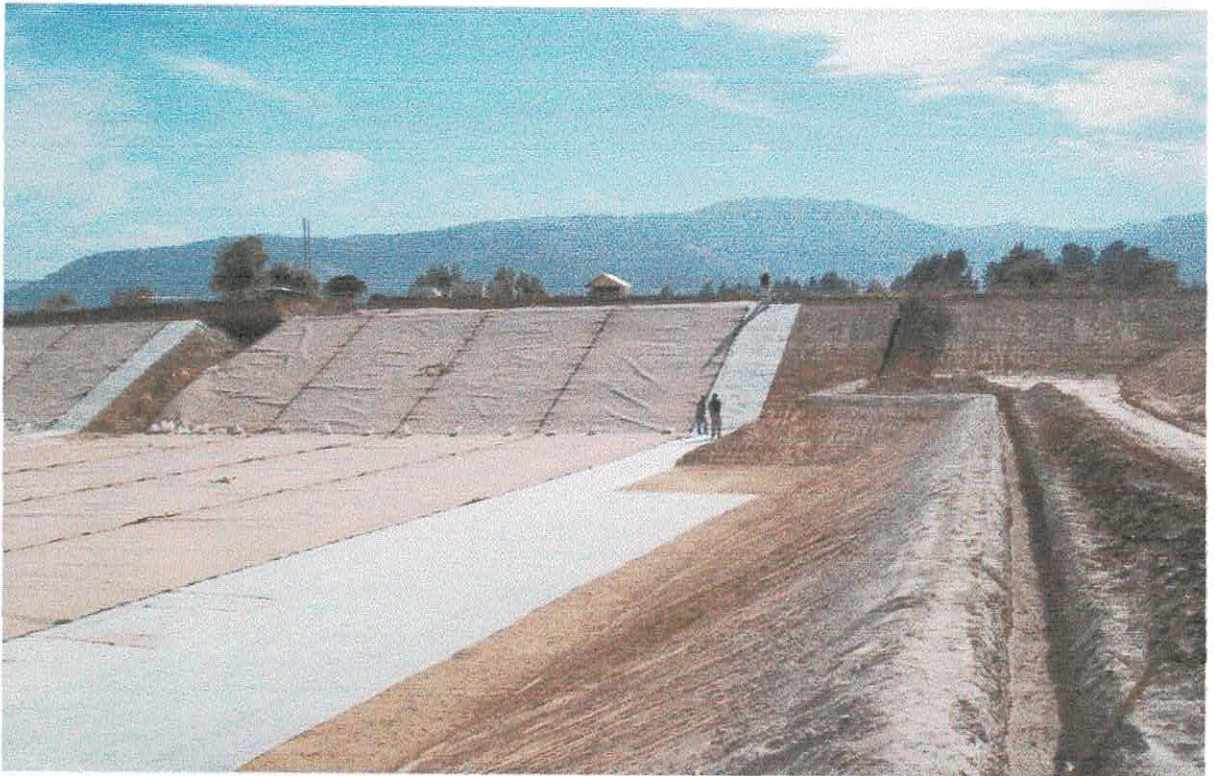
Instalación de la Impermeabilización Basal del Primer Sector de Disposición -
